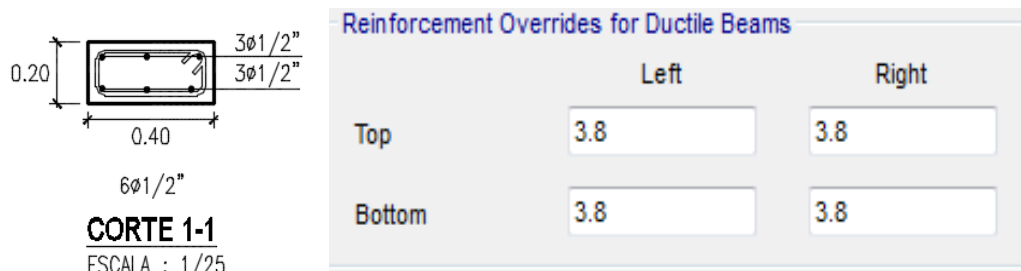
Detalle de refuerzo en vigas V-106 y V-206.
